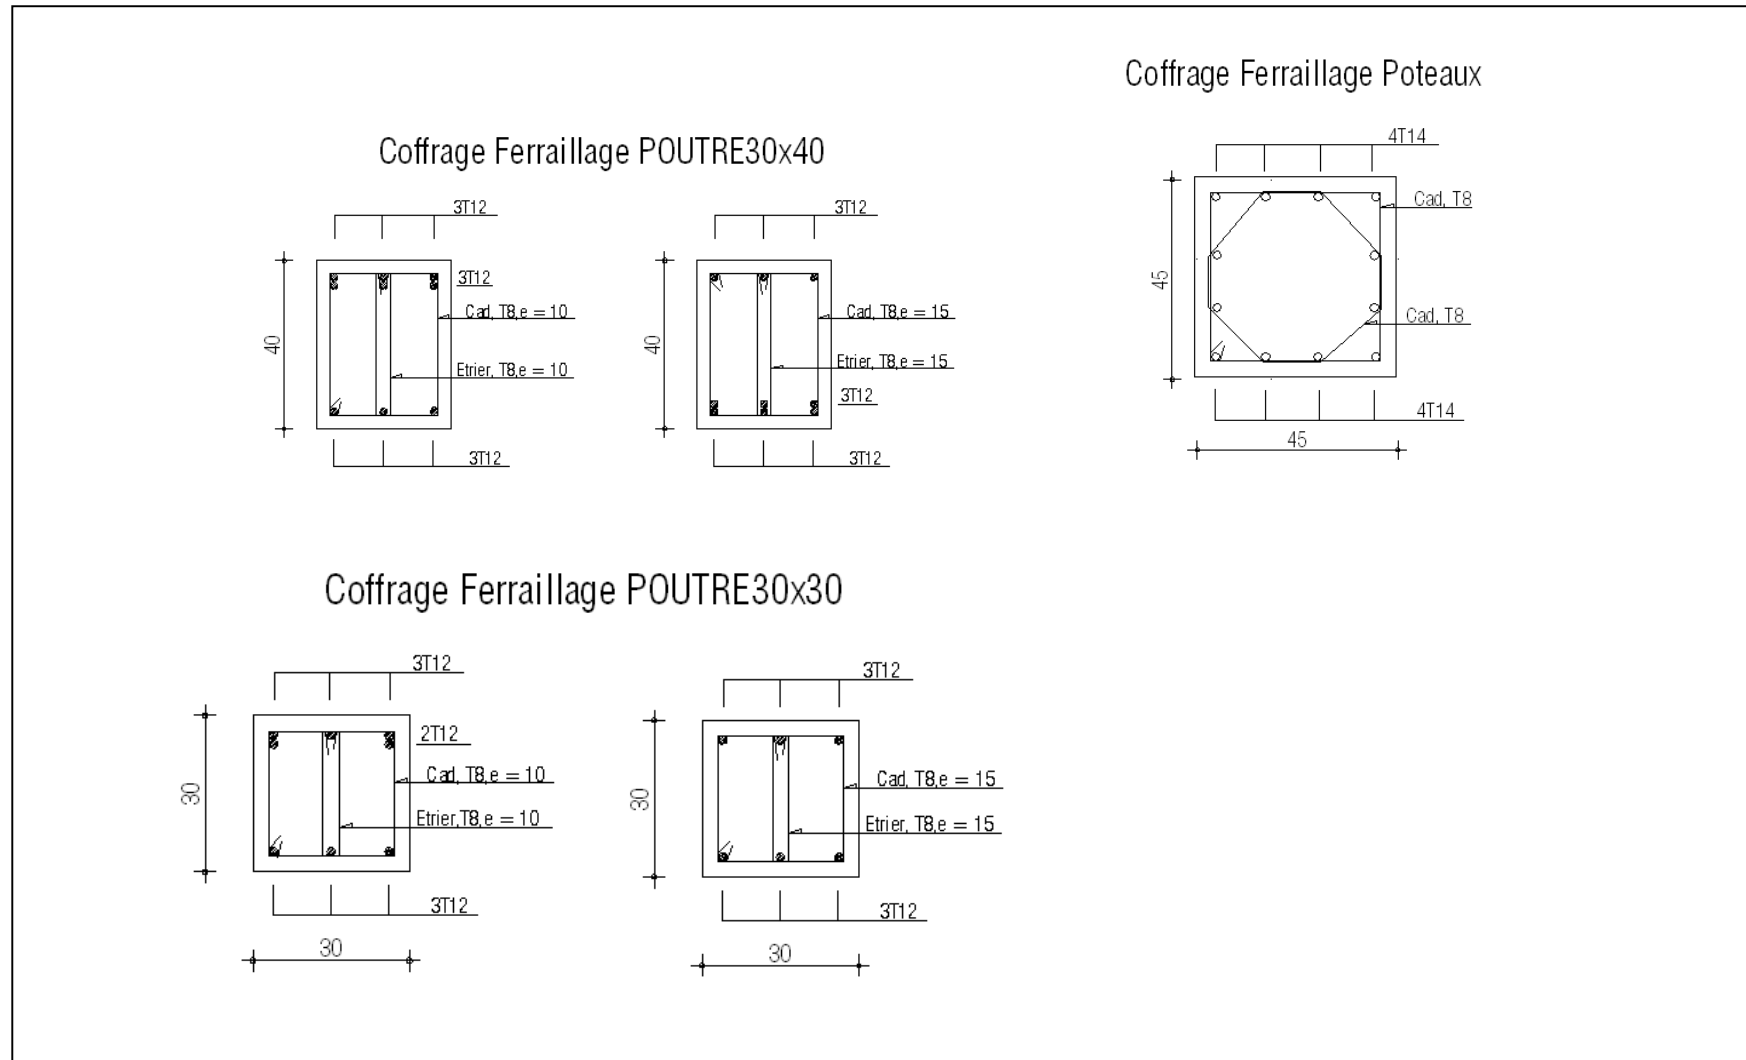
Ferrailade des éléments structuraux (poutres, voiles)
